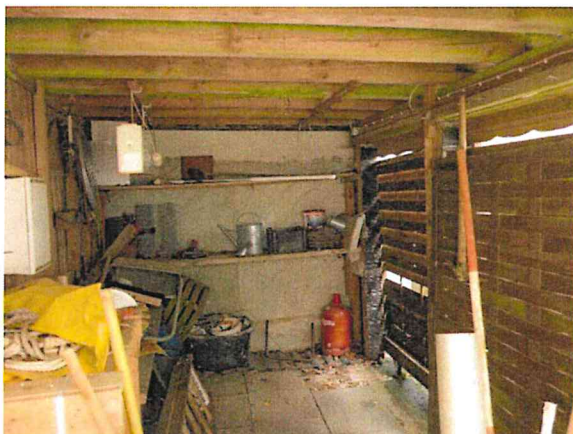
offener Schuppen mit Nischen unterm Dach (pot. Brutplätze)
